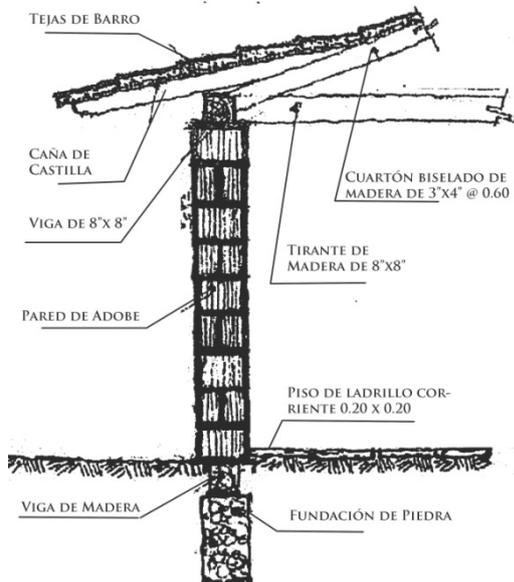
SECCIÓN TÍPICA ADOBE.
